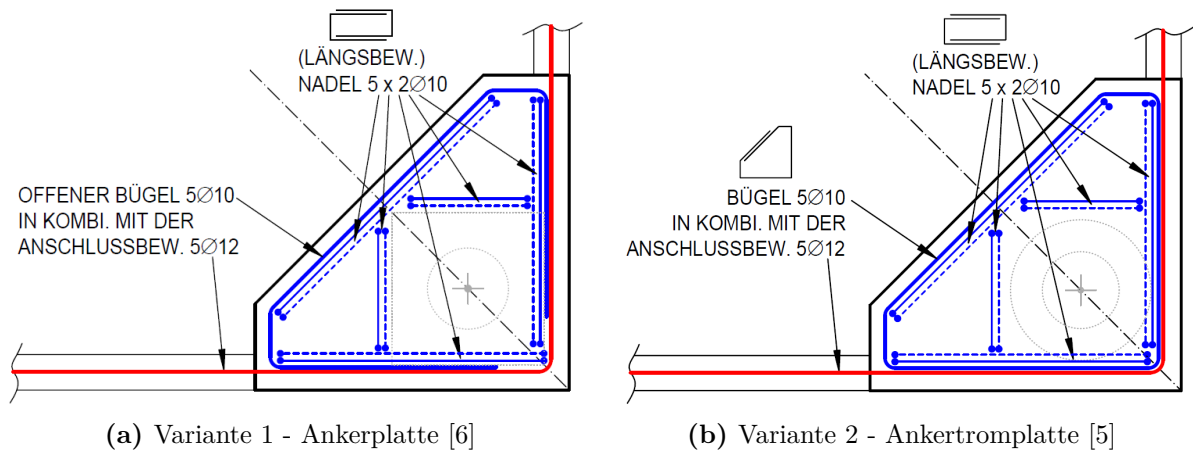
Konstruktive Bewehrungsführung (blau) und Anschlussbewehrung (rot)
